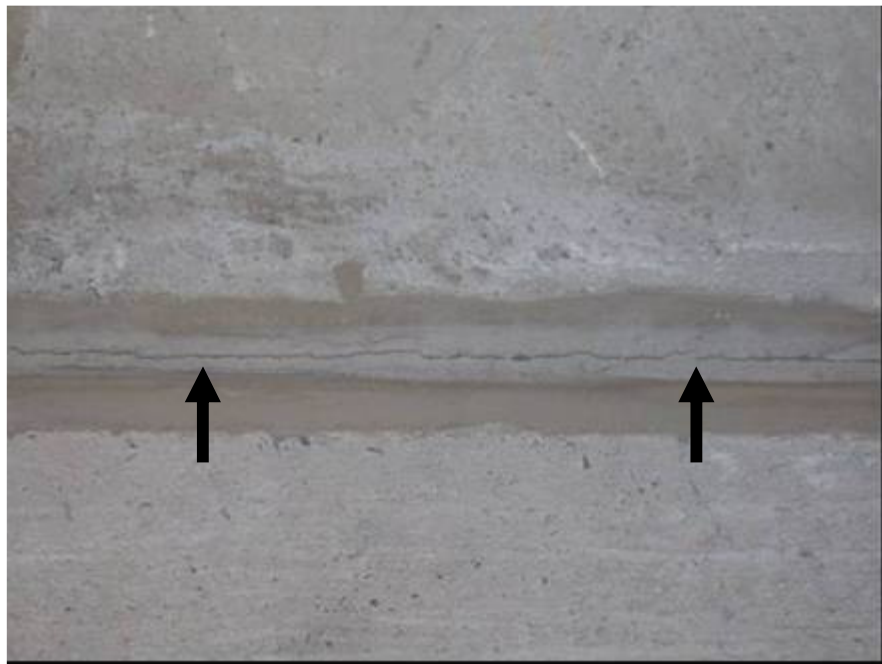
Placas montadas para o teste, visível microfissuras horizontais causadas pelo ajuste do aparelho.
